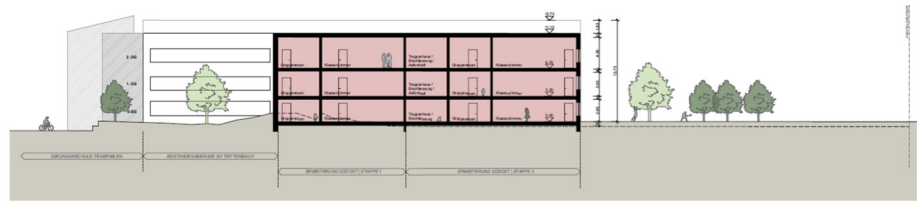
Disposition 01 | Gebäudeschnitt A-A
